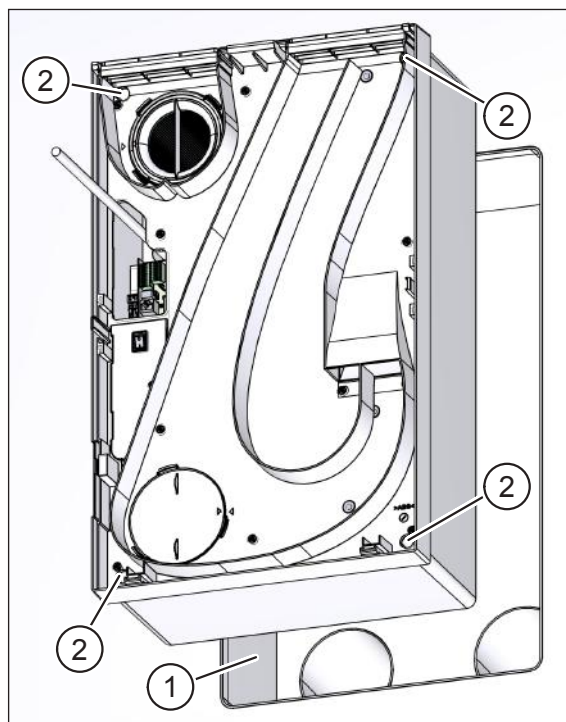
закрепить вентиляционную установку – встроенный монтаж
